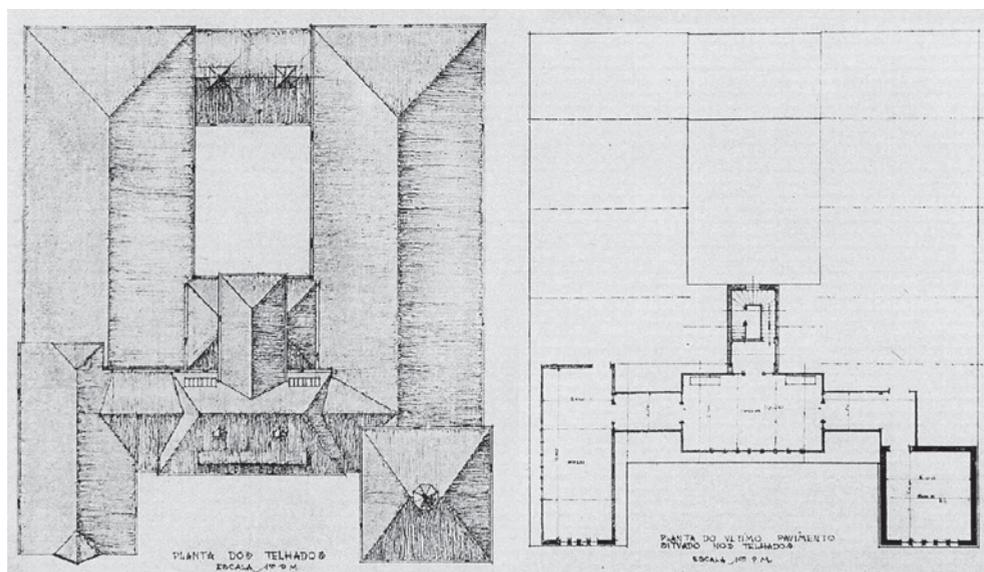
Grupo Escolar de Nova Friburgo: Planta baixa do telhado
